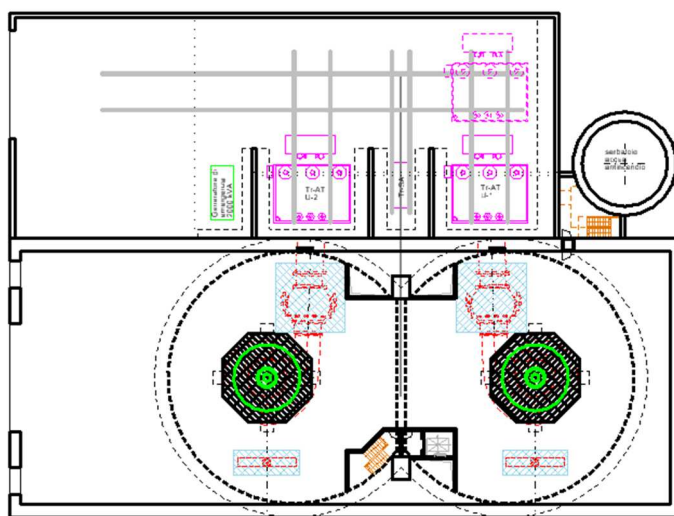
Pianta del piano -263,30 (estratto Tavv. PD-EP.18.2).
